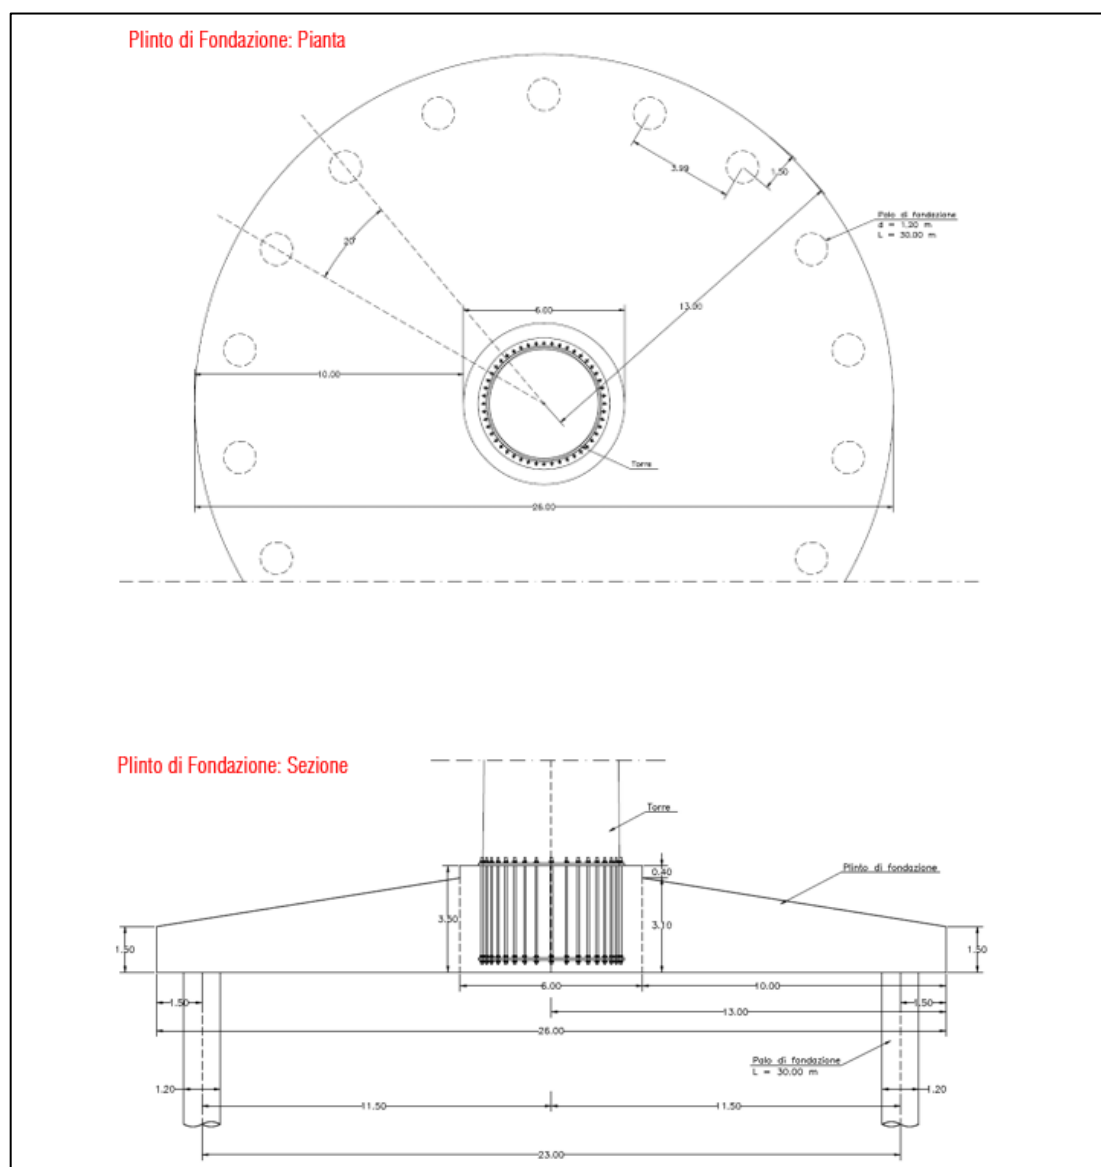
Vista planimetrica e vista laterale del plinto di fondazione (Cfr. elaborato cod. PD.35-Carta del Plinto di Fondazione)
